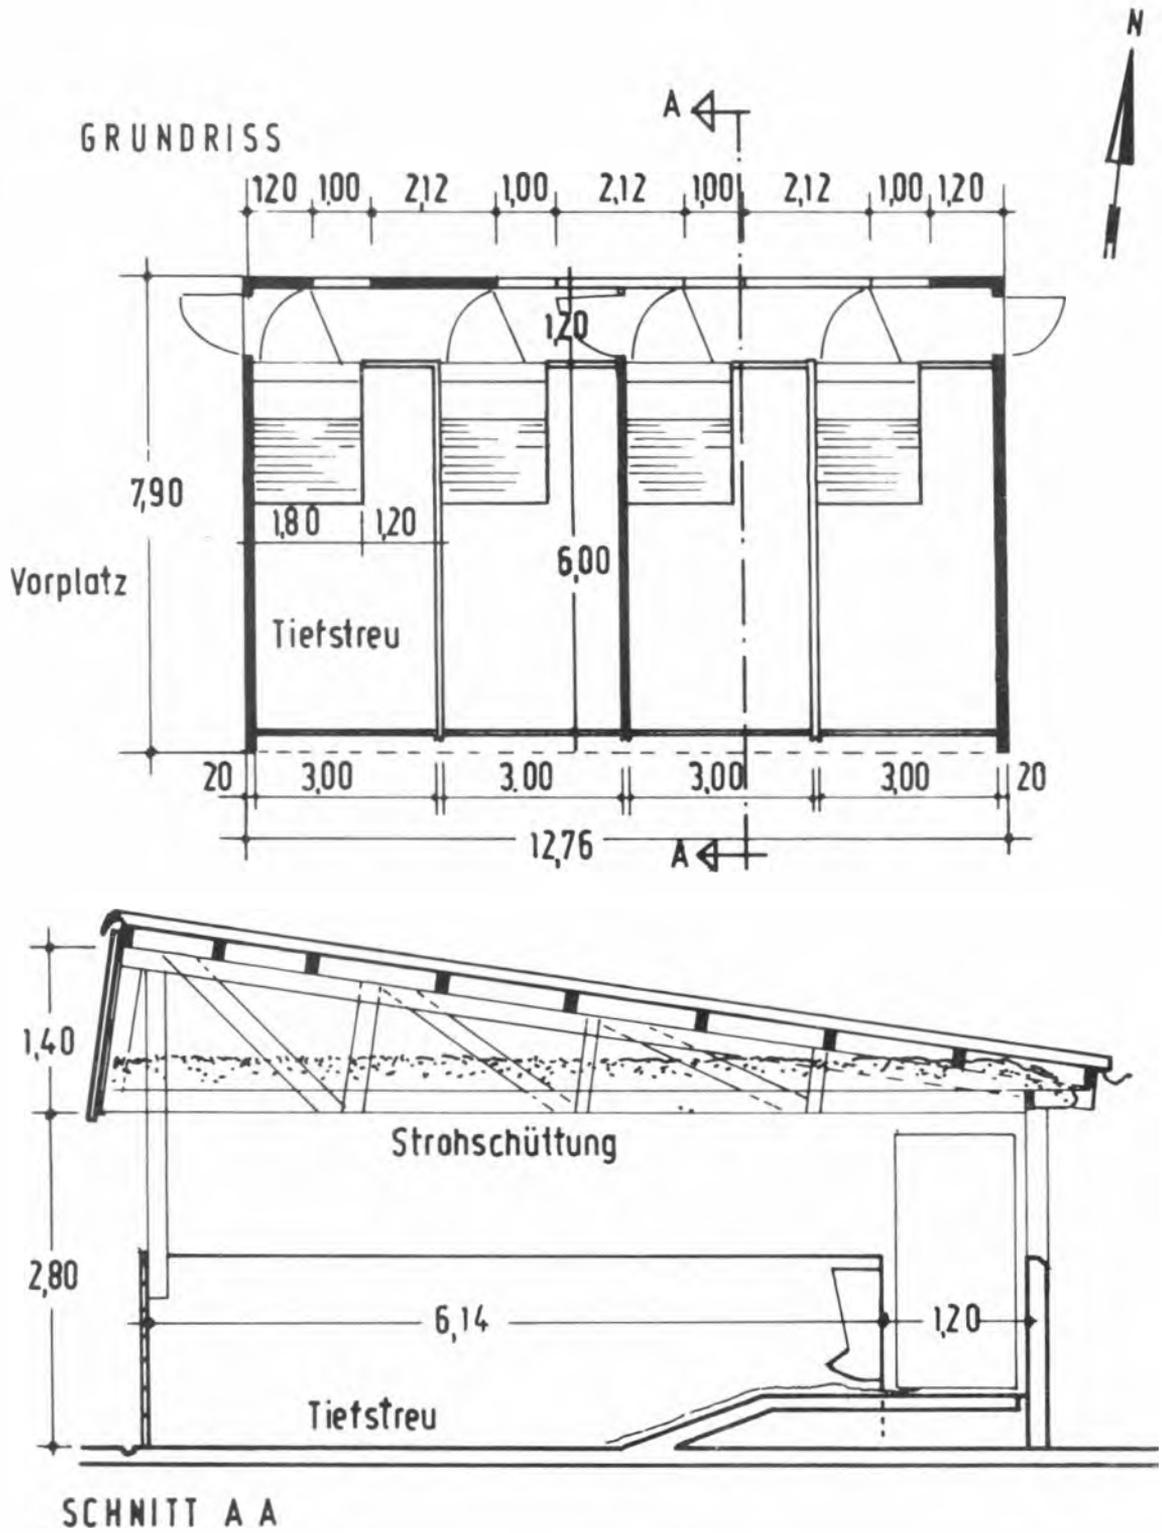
Grundriß und Schnitt des Offenfrontstalles
